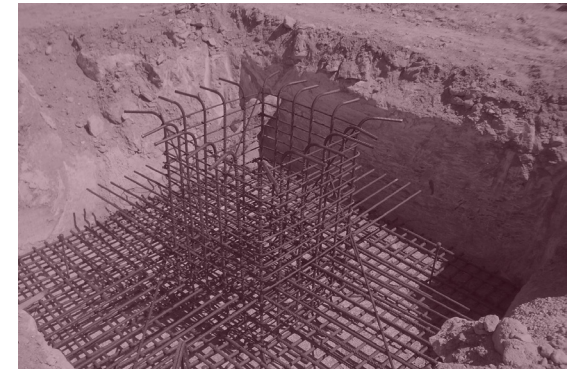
Fotografía en obra de una de las zapatas de la bodega protos. (Fuente: Elaboración propia a partir de la documentación facilitada por Rosa Bellido Pla).
